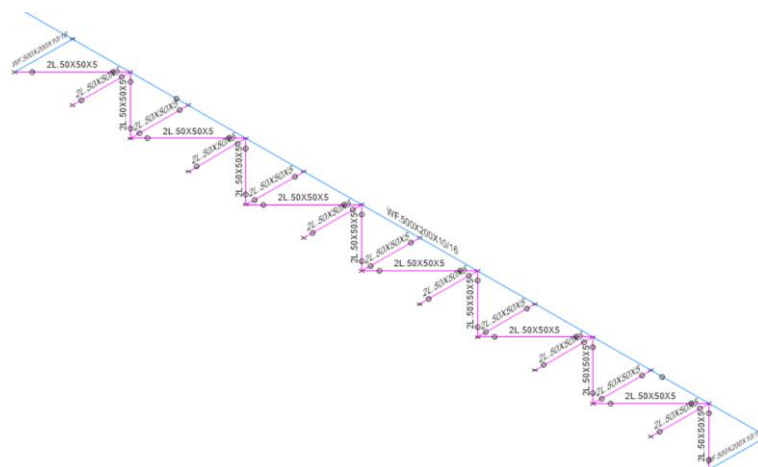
Edit → Extrude → Extrude Joints to Frames
